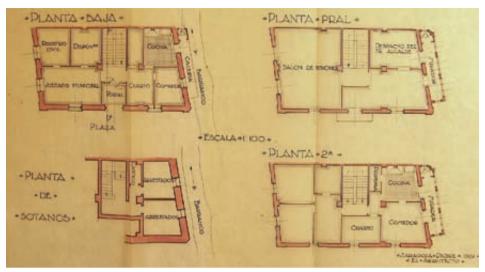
Plantas de sótanos, baja, principal y segunda del proyecto de ayuntamiento de Gallur, 1927 (A.D.P.Z.).
